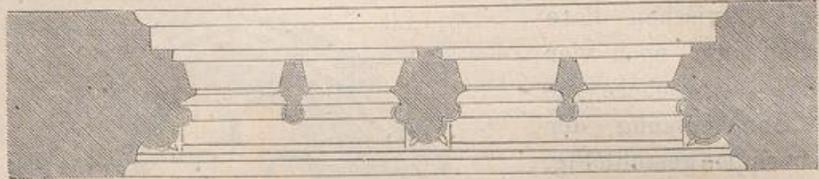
Grundriss eines Fensters zu Obermarsberg.
